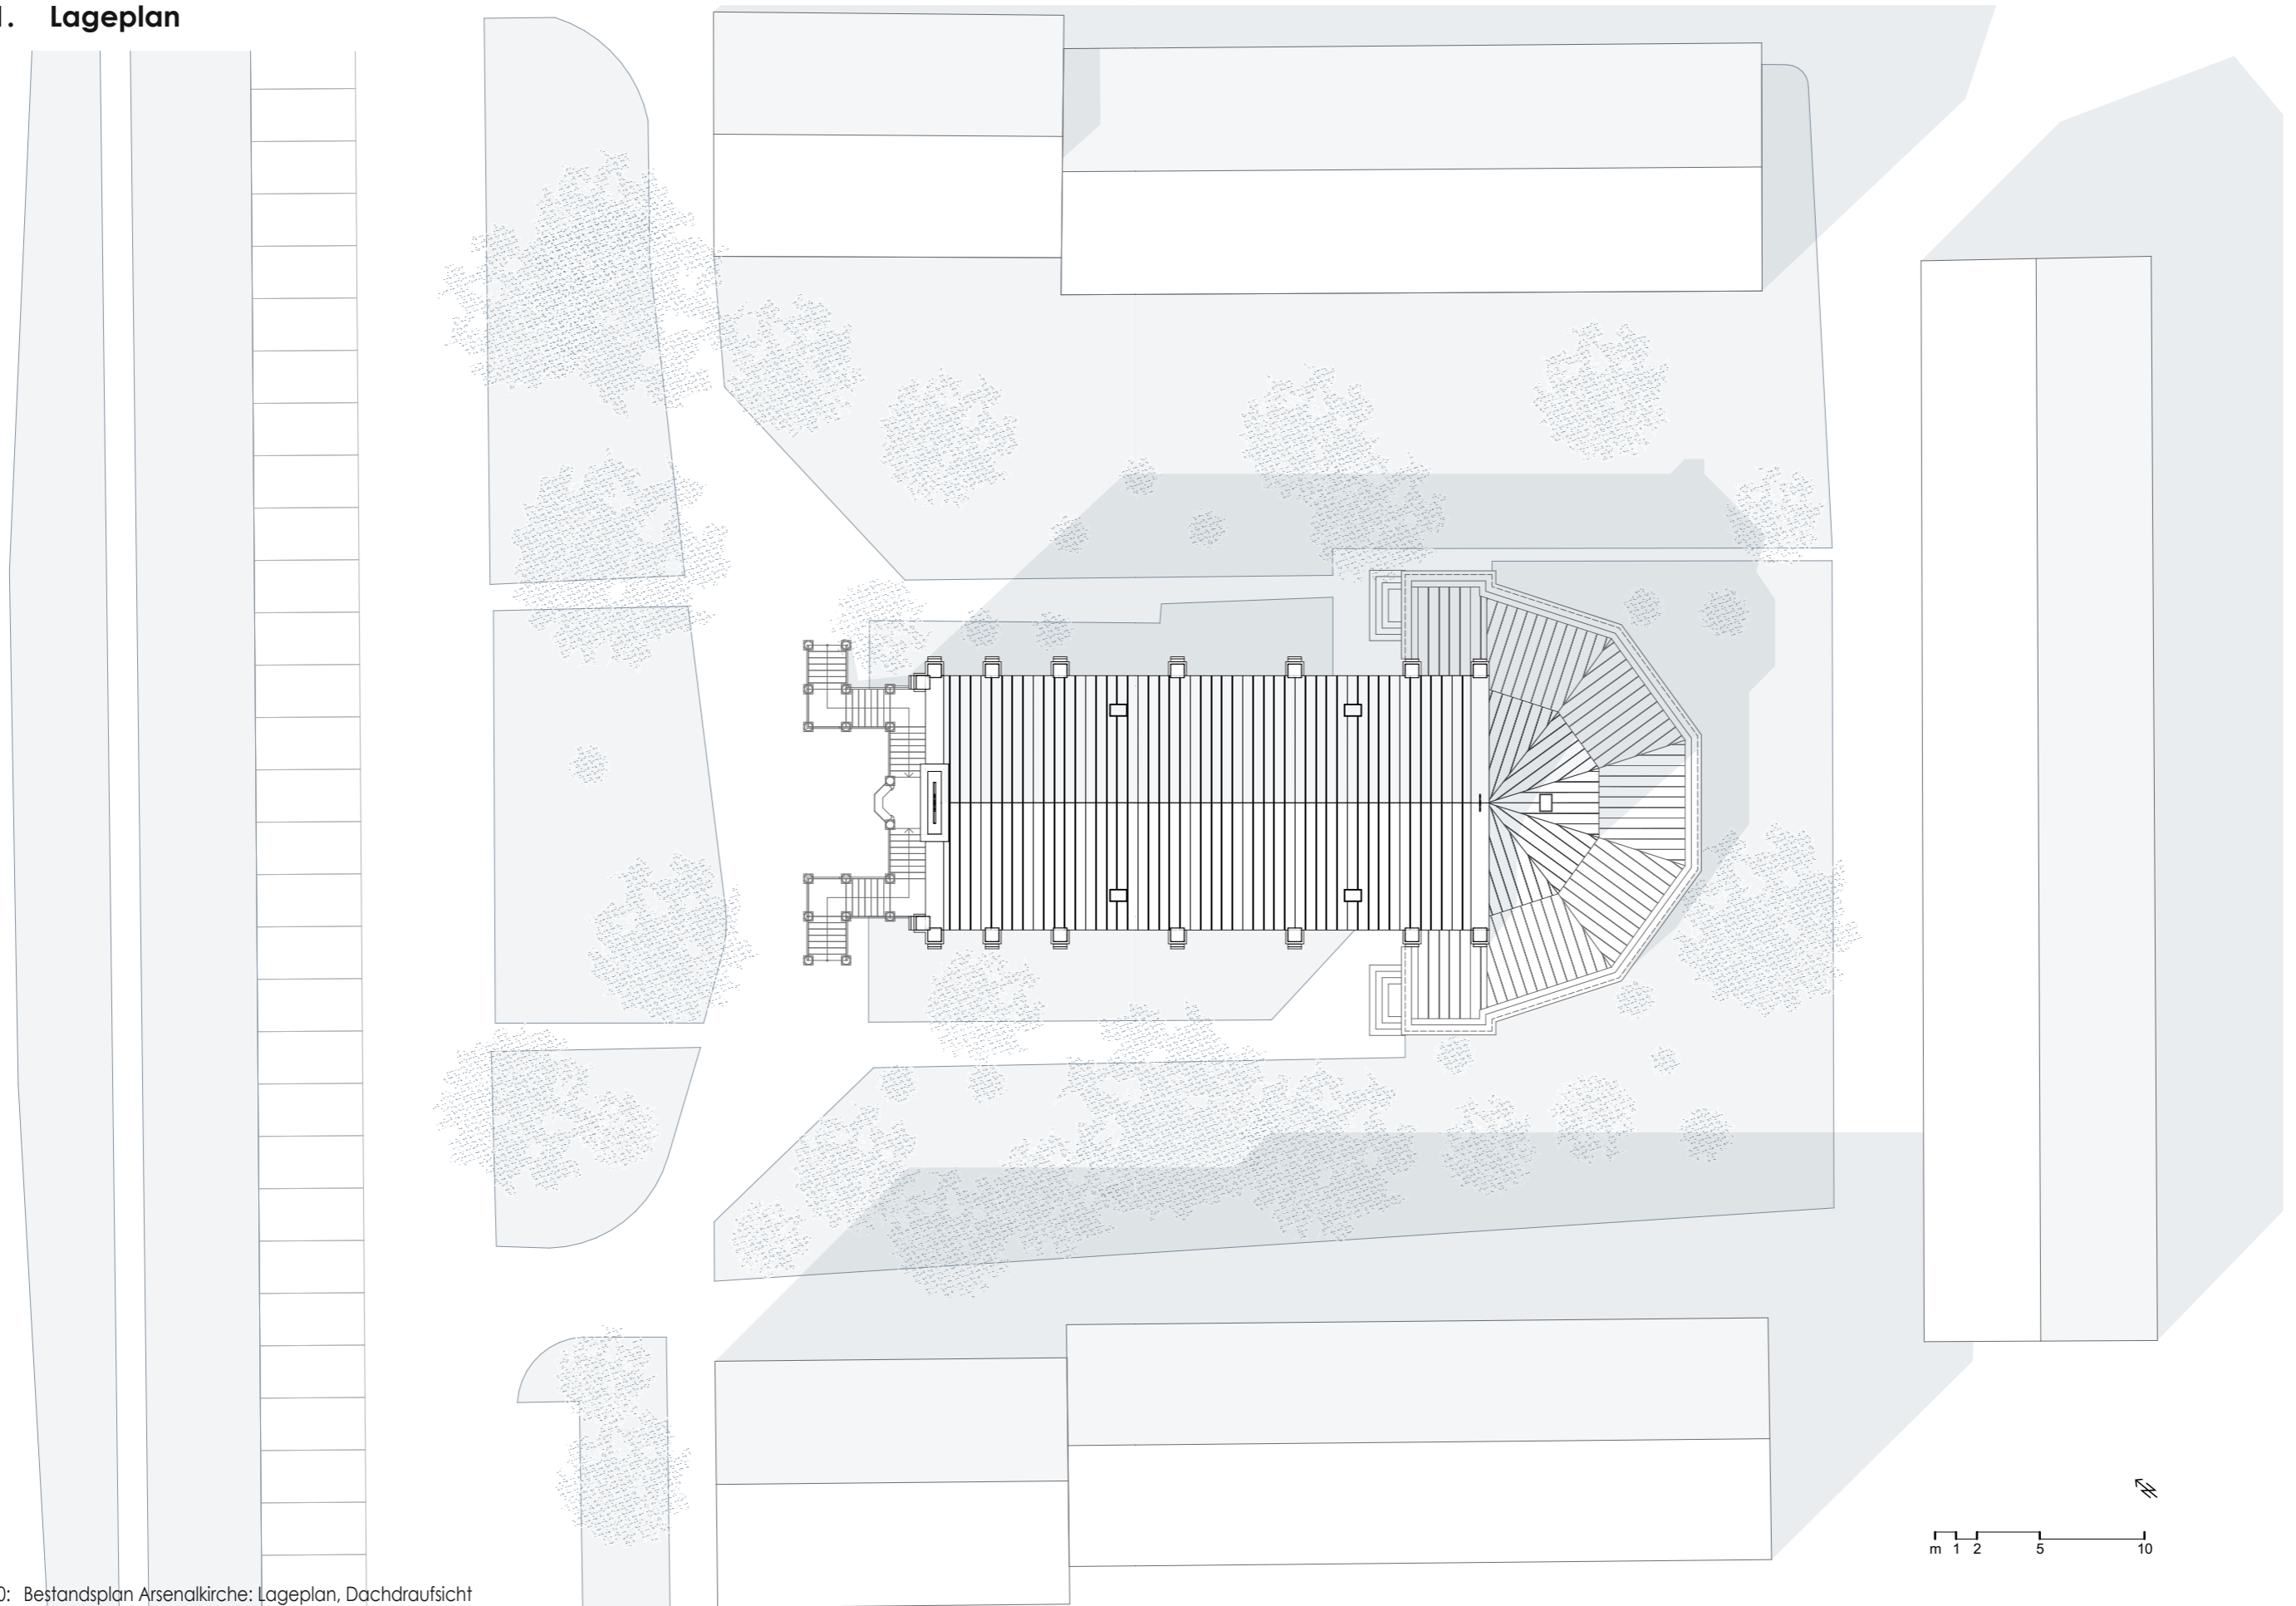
Bestandsplan Arsenalkirche: Lageplan, Dachdraufsicht
